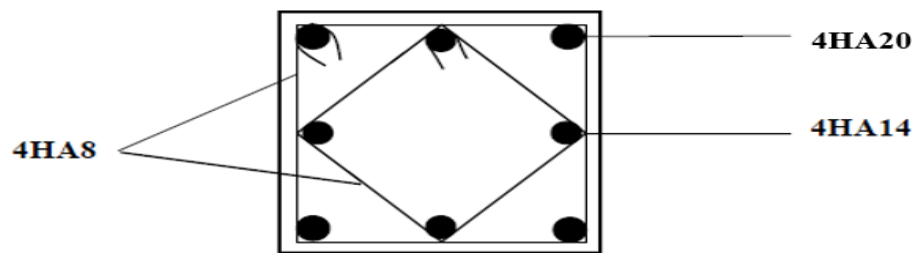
Schéma de ferrailage des poteaux RDC et 1<sup>er</sup>.2.3<sup>ème</sup> étages
